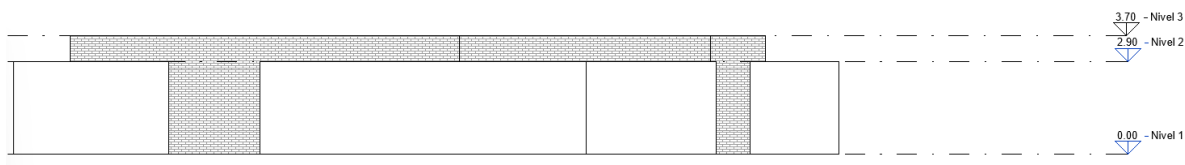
Alzado Oeste modelo levantamiento con Dron LiDAR. Fuente: elaboración propia.
